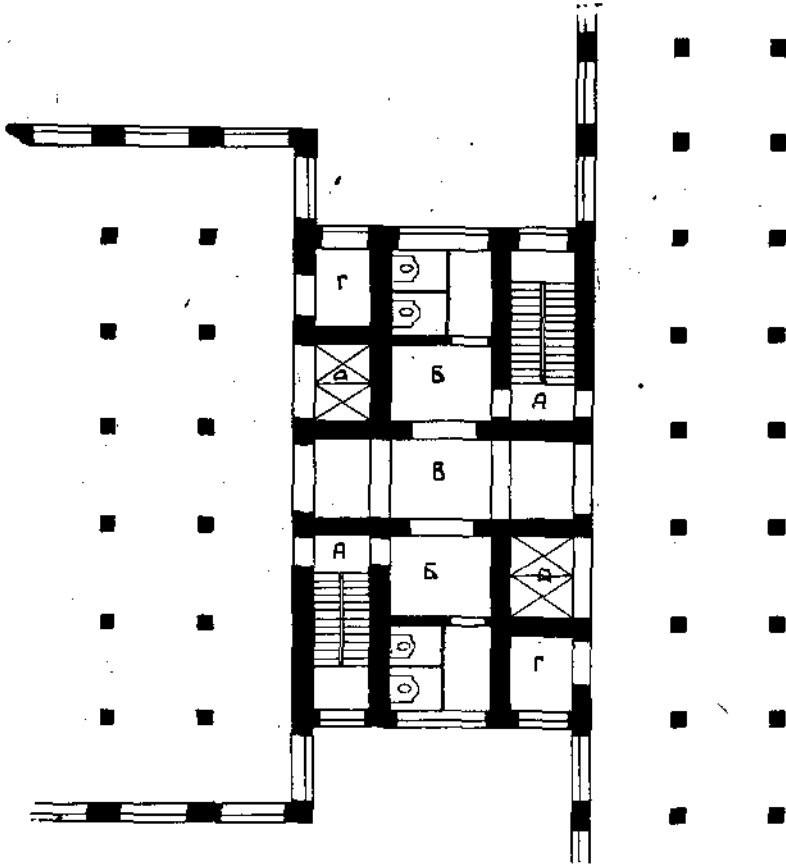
План уборных, умывальной и лестницы в углу многоэтажного фабричного здания.
